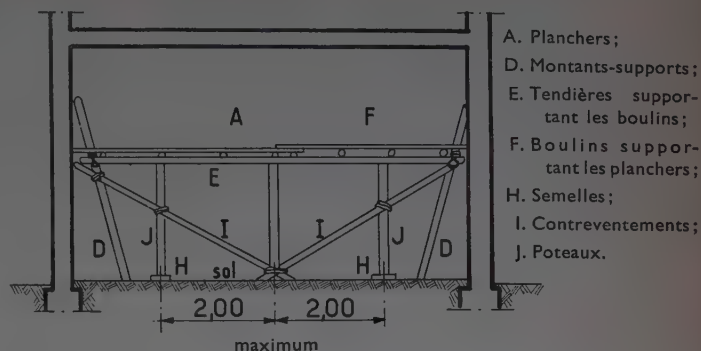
Échafaudage de pied, sur plan horizontal, sur poteaux.
